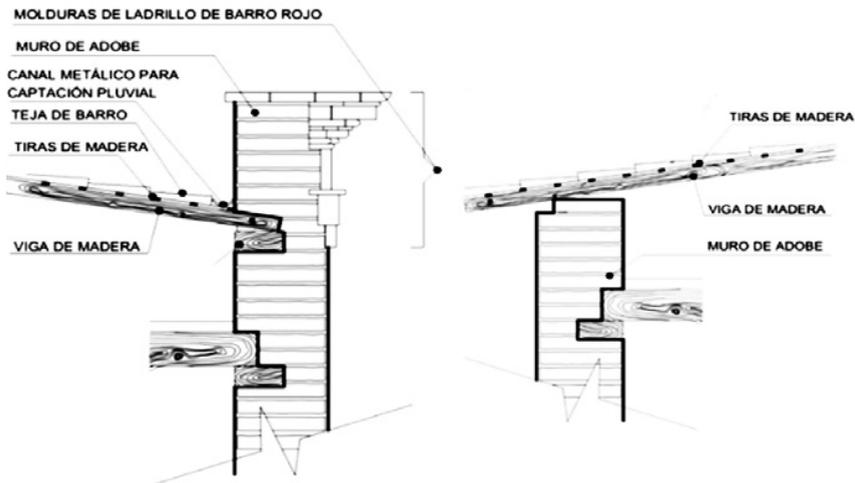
Detalles de cubiertas en viviendas de Calimaya. Croquis: Jorge Pérez, 2012.
